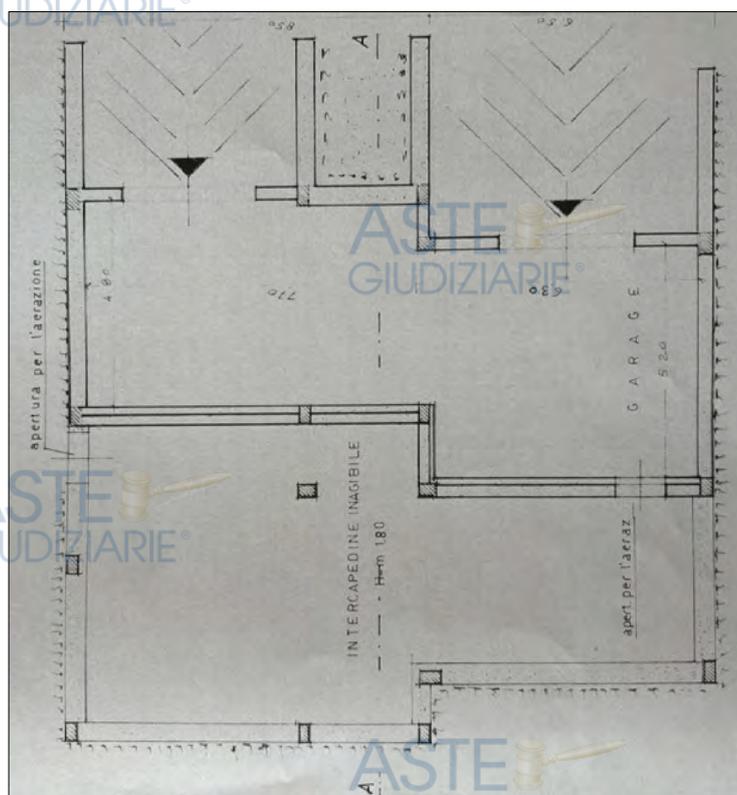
Pianta piano seminterrato variante n. 77 del 24/12/1996.
